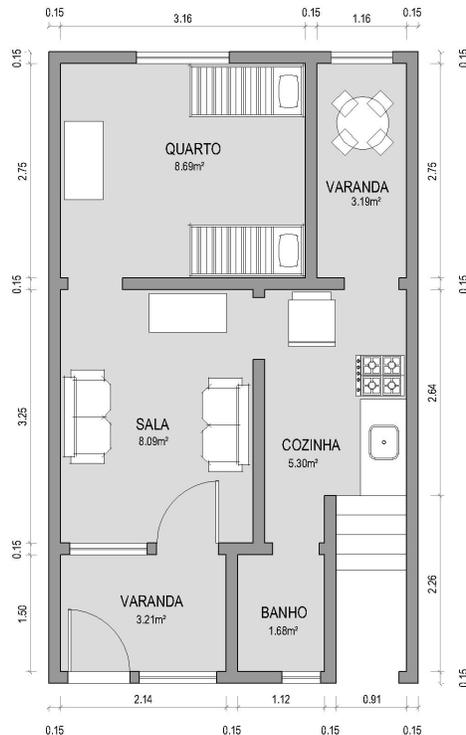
Planta baixa da casa do Sr. Edenilson. Área: 30,16 m².
